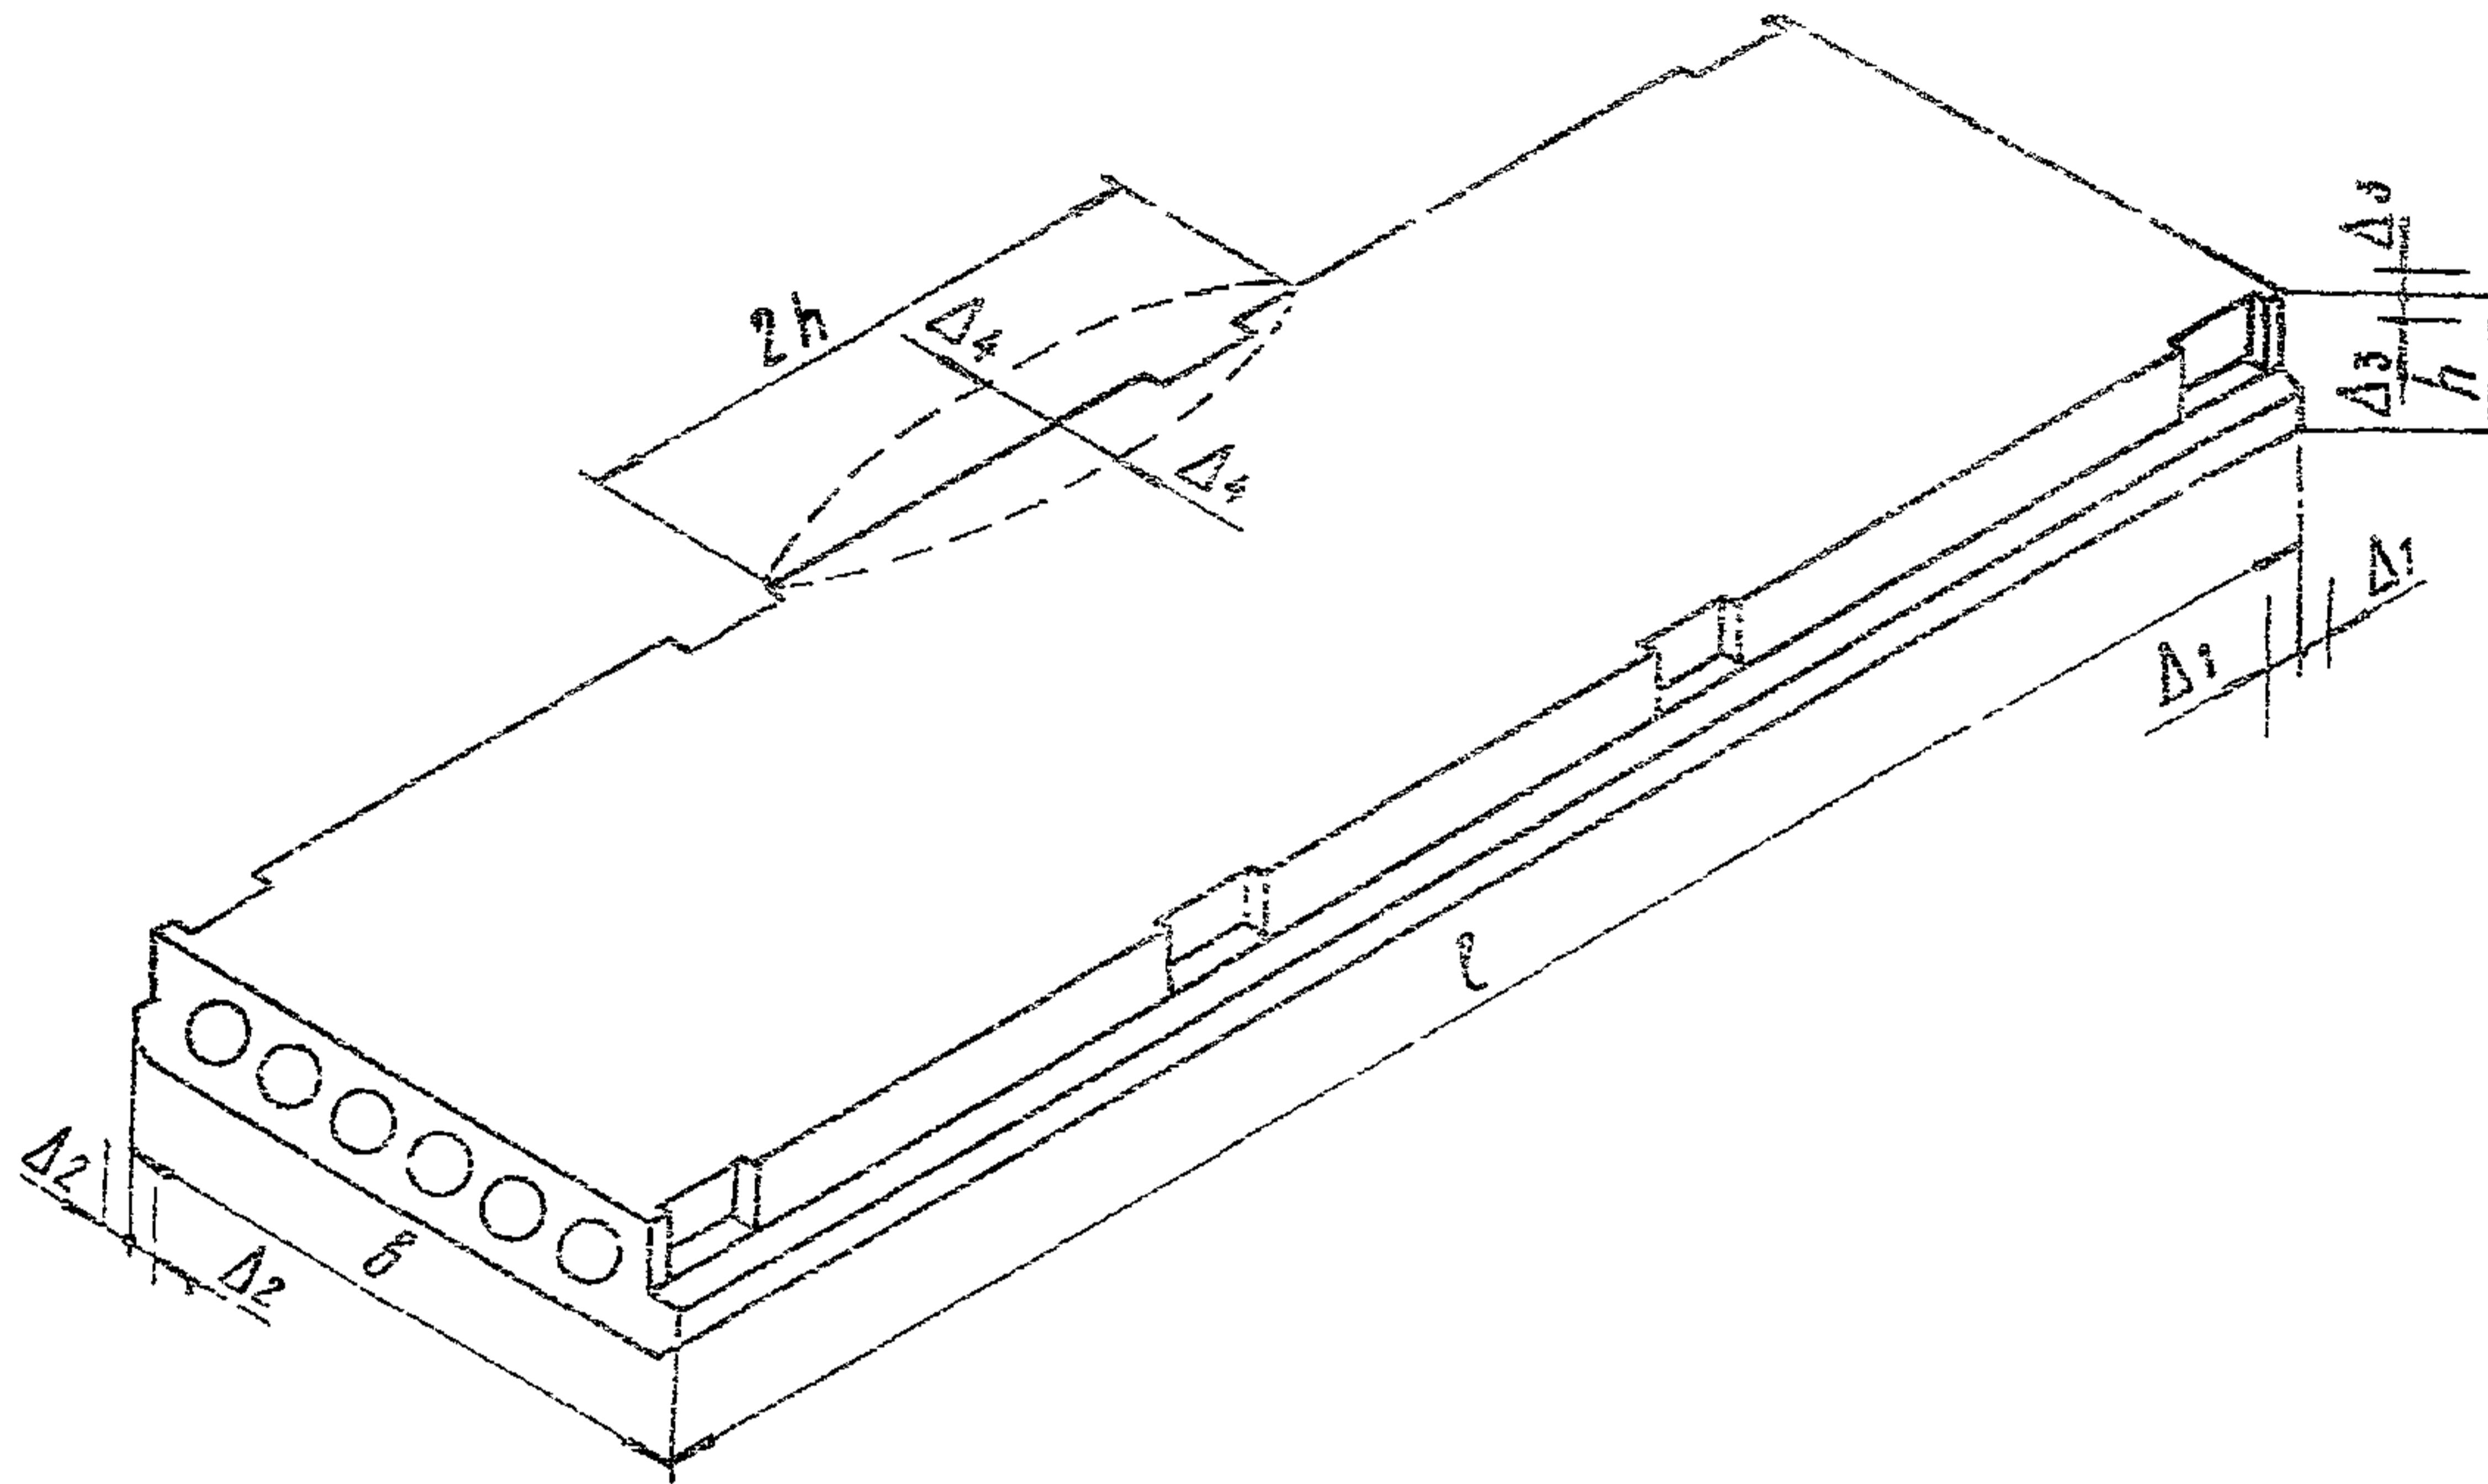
Рис. I. Схема плиты перекрытия ПФЗ-58-12 с
